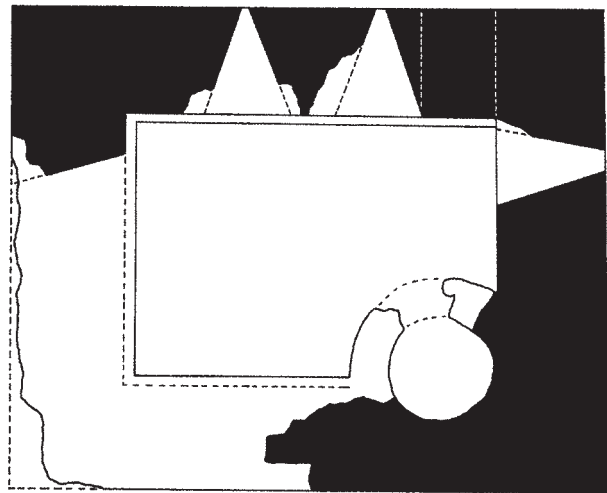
Ainos. Objekt B: schematischer Grundrissplan. – (Plan H. Bücherl, RGZM).
